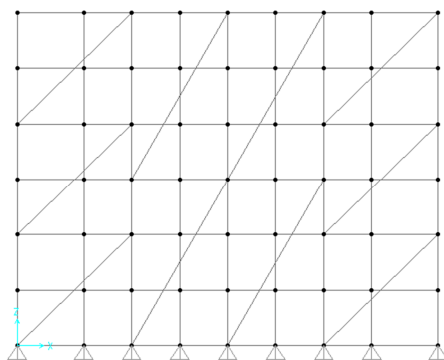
Configuração dos Planos de Contraventamento Vertical Com Elementos de Contraventamento Grandes
